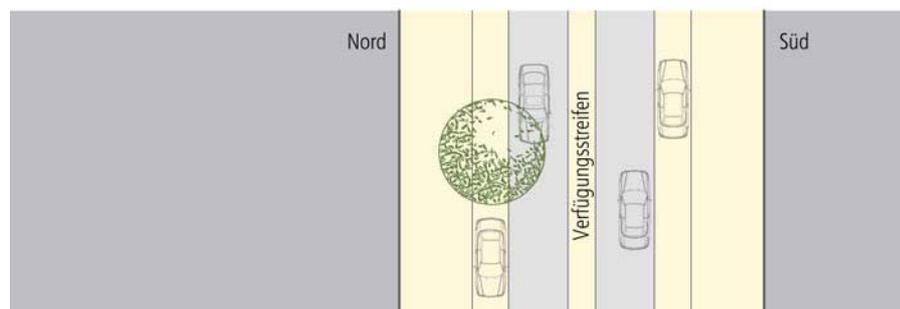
Schnitt Straßenplanung Bahnhofstraße
